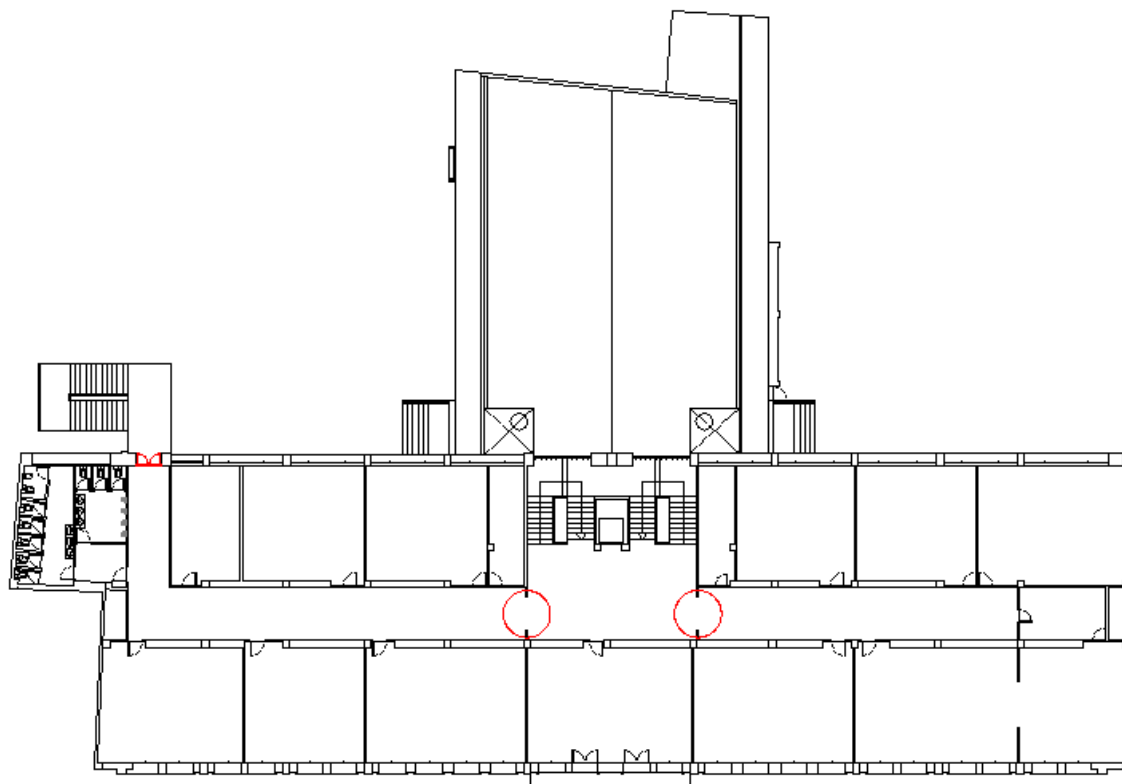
Puertas situadas en recorrido de evacuación en planta segunda. Fuente: Elaboración propia.
